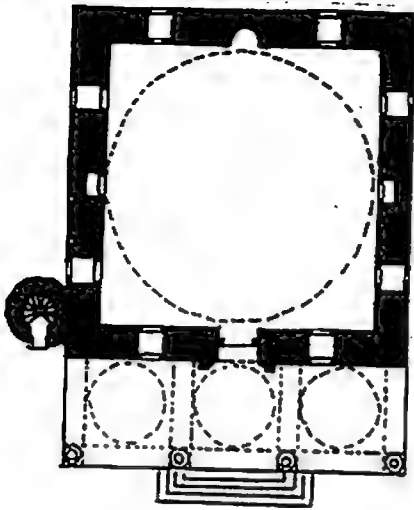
للمسقط الأفقي لجامع مراد باشا في إستانبول .
